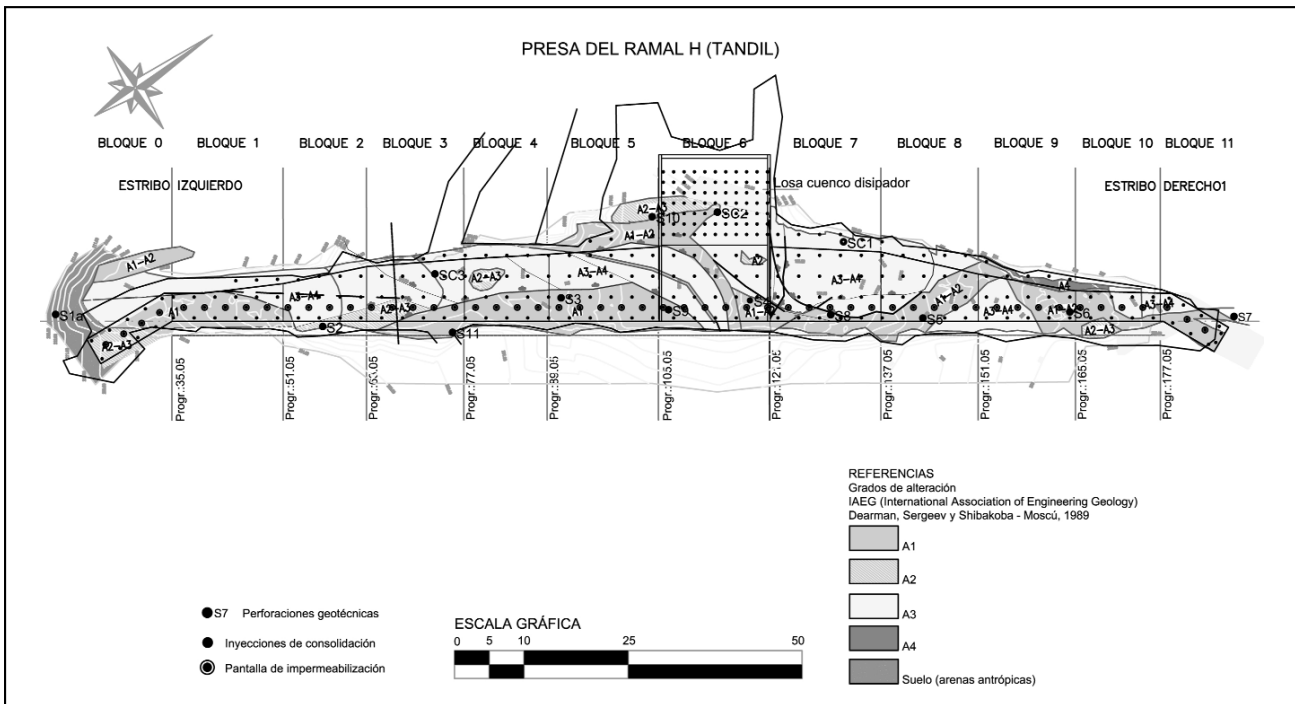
Planta - Plano Relevamiento Geotécnico - Alteración / Planta taladros de inyección primarios.
